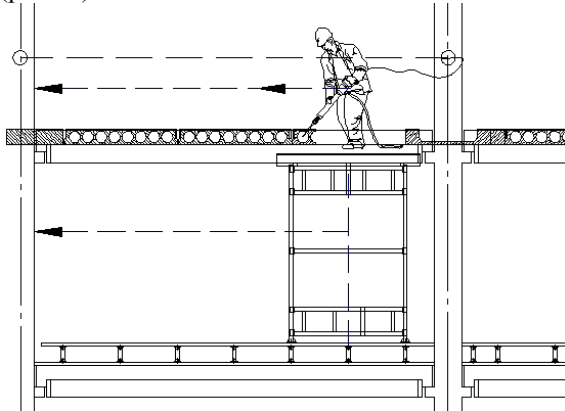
Схема виконання робіт при видаленні збірної порожнистої залізобетонної плити перекриття
